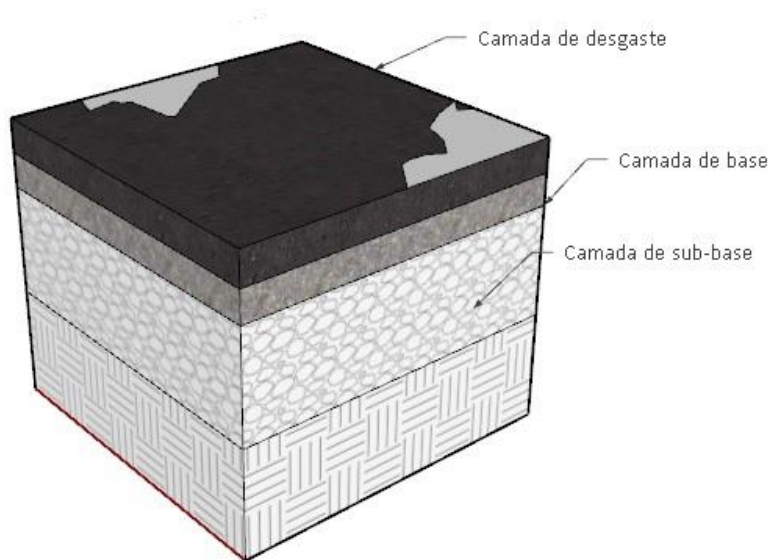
Camadas do pavimento (adaptado de Tenreiro, 2016)
